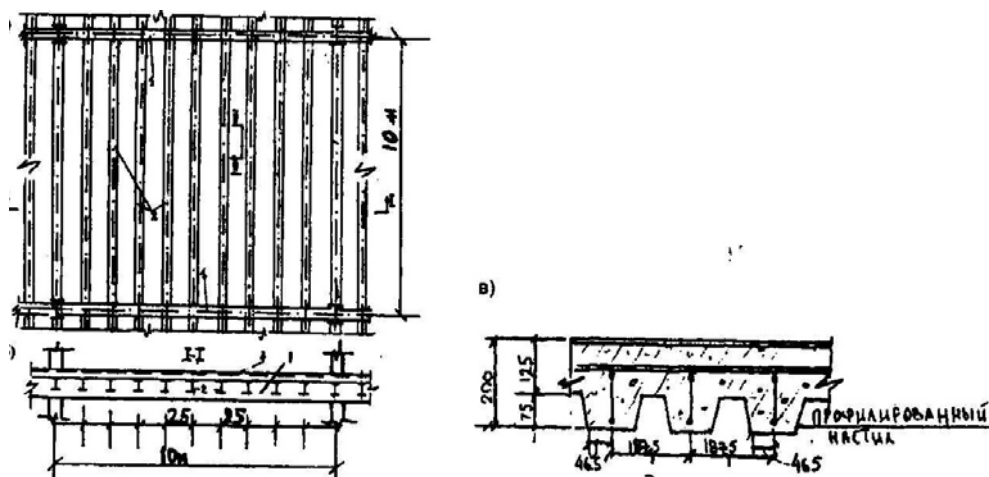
а – фрагмент перекрытия здания ОАО «Рускарт», б – вид по 1-1, 1- главные балки – сварной двутавр 690х320, 2 – второстепенные балки – сварной двутавр 462х250, в – железобетонная плита перекрытия (по 2-2)
